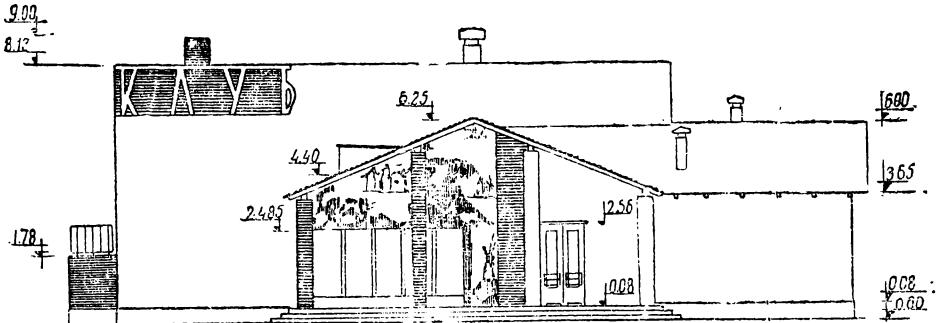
Главный фасад здания клуба со зрительным залом на 100 мест
